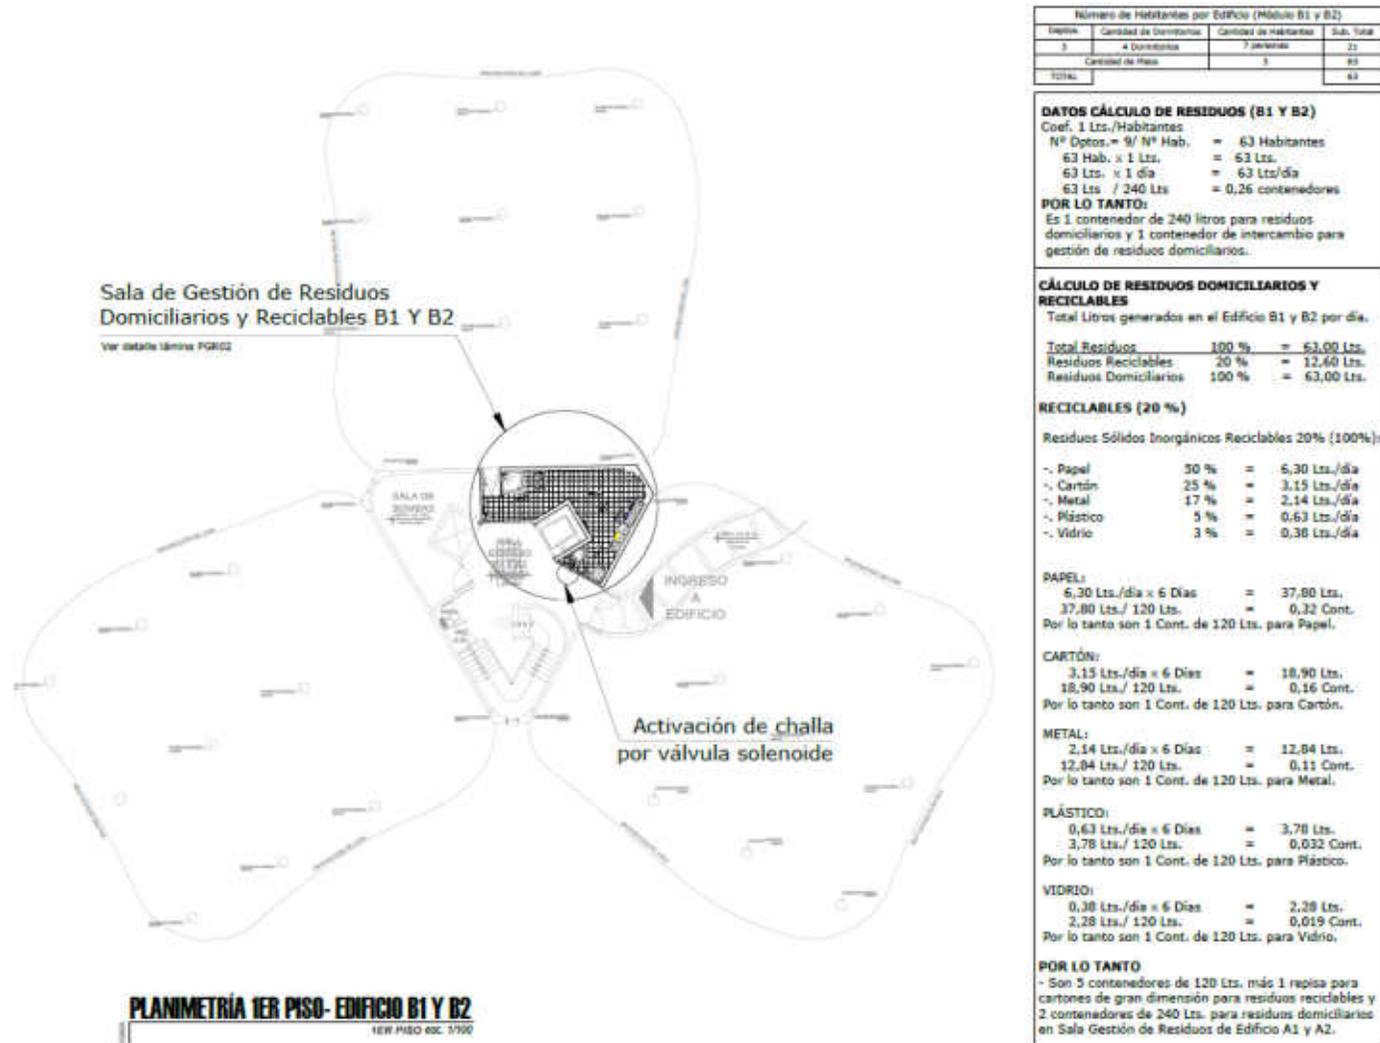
PSGR - Planimetría 1er Piso – Edificio B1 y B2 – Datos de cálculo de Residuos
